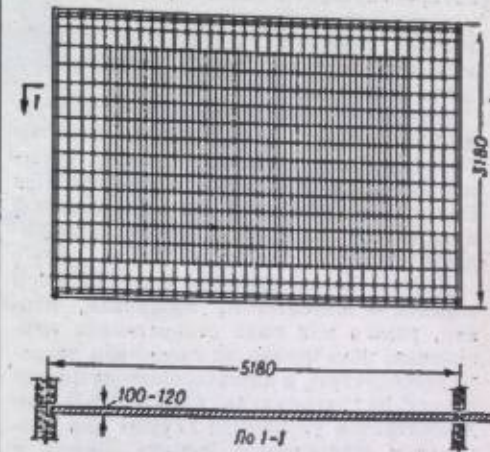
Сплошная железобетонная панель междуэтажного перекрытия размером «на комнату».
